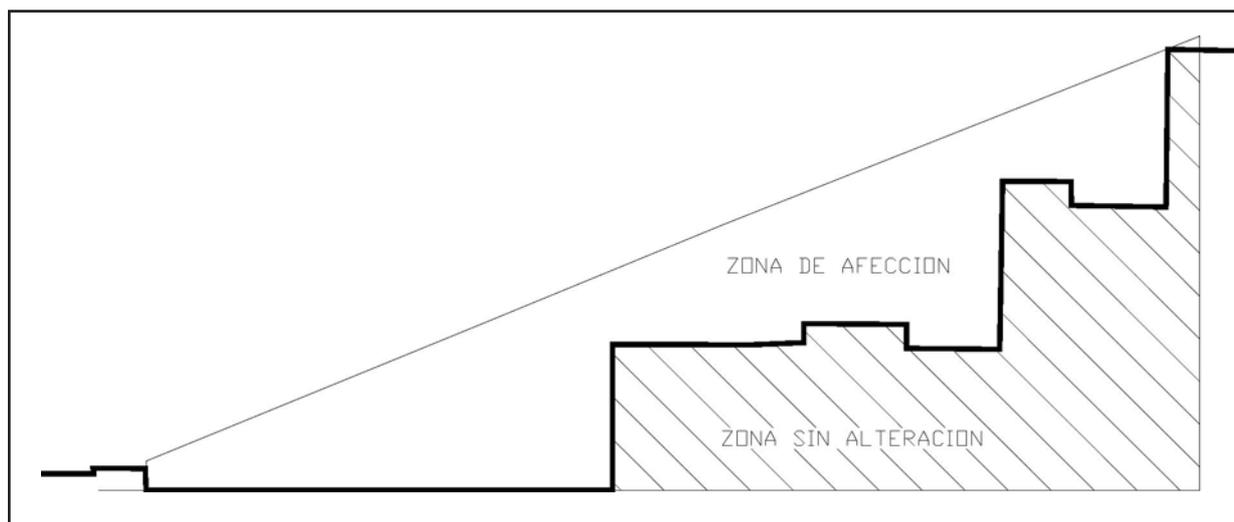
Alzado del Proyecto de Construcción de una vivienda unifamiliar.
